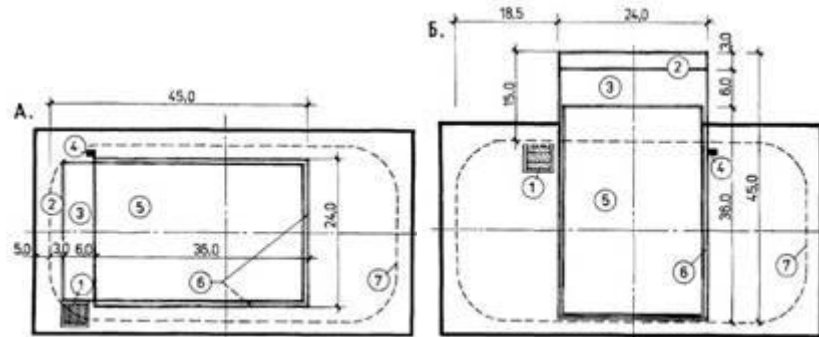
План арены для проведения выступления балета на льду (размеры в метрах)
